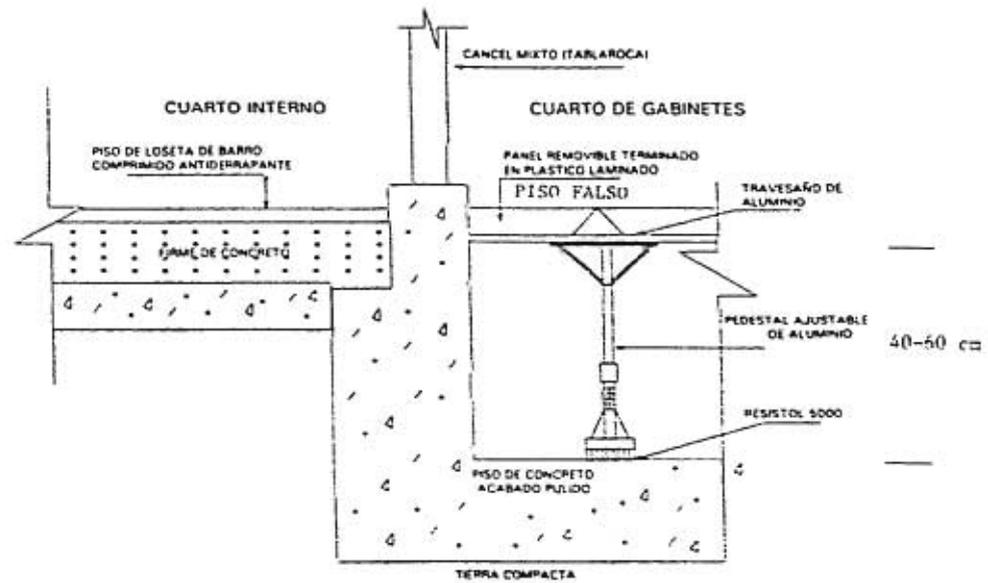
DETALLE CONSTRUCCION DEL PISO FALSO
